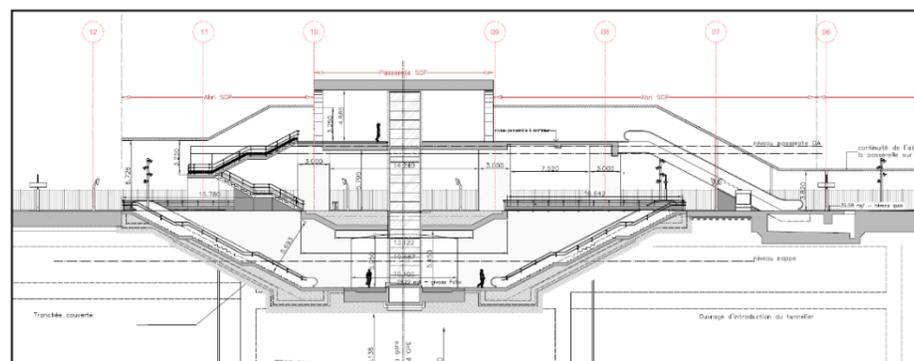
Ardoines - Coupe longitudinale sur les quais
